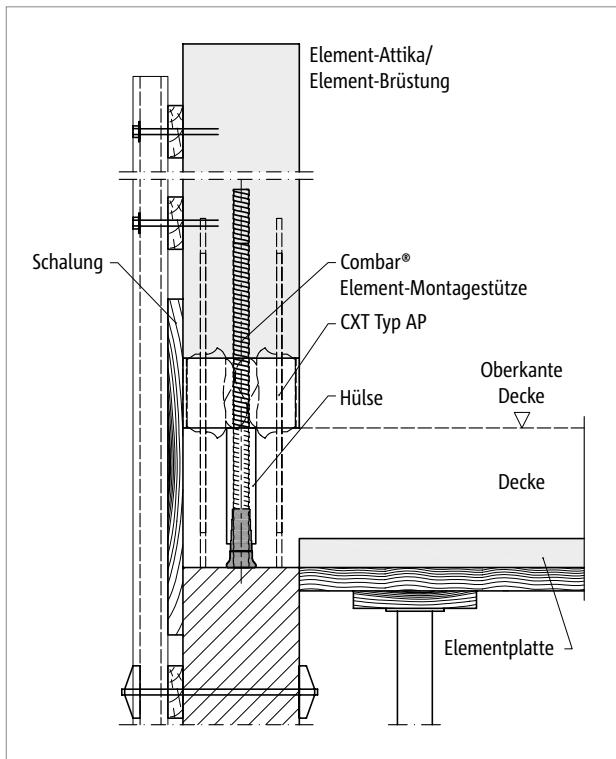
Schöck Combar® Element-Montagestütze: Einbau einer Elementattika; Schnitt
